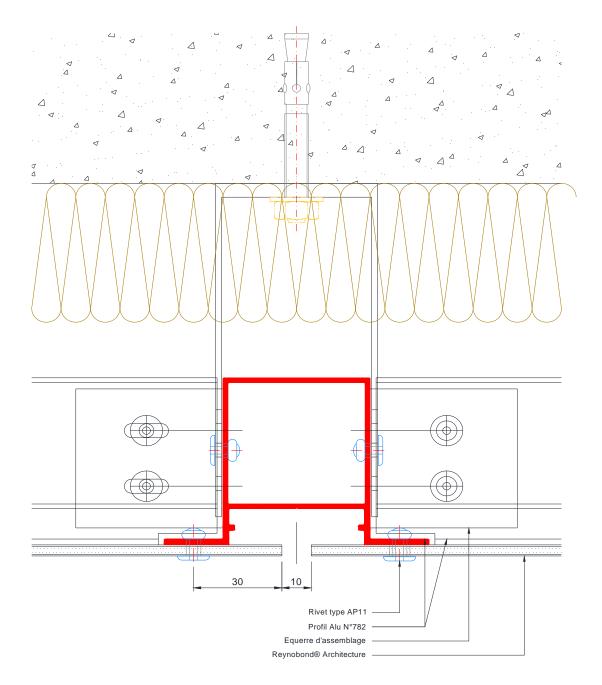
Joint vertical - Coupe horizontale – Système riveté RV 60 4c
